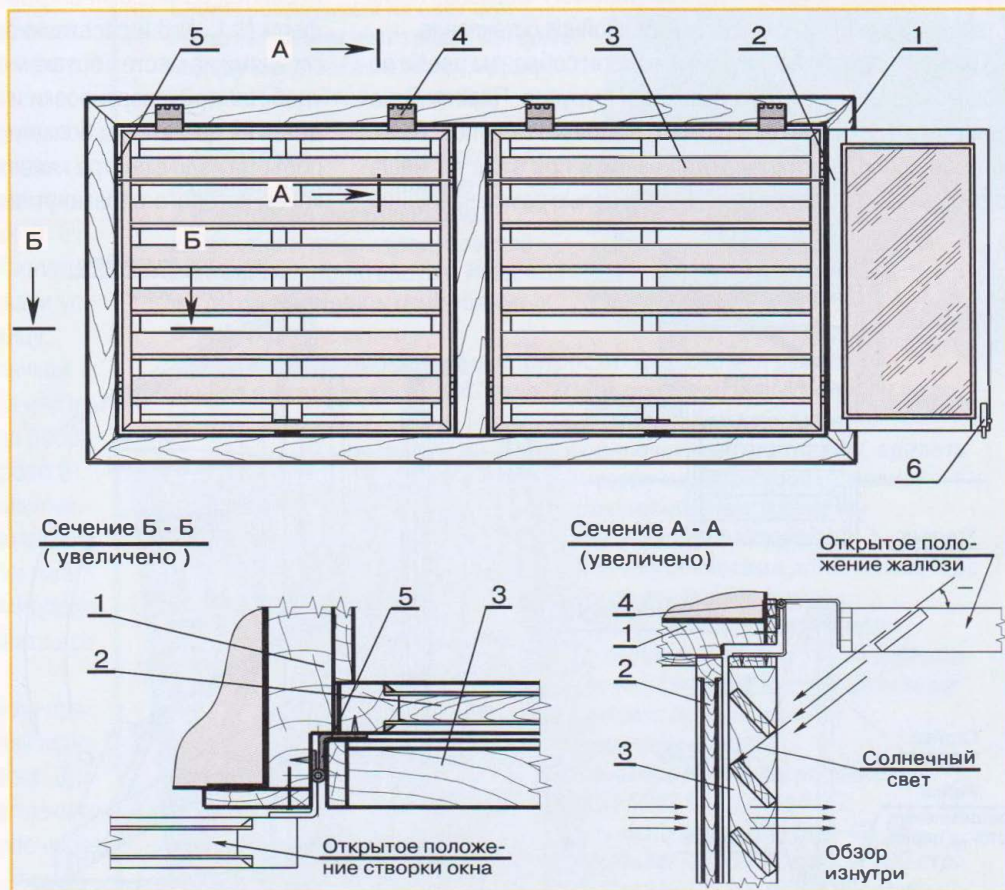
Конструкция оконного блока с двойным остеклением и решеткой жалюзи: 1 — коробка; 2 — створка; 3 — жалюзи; 4, 5 — шарниры; 6 — шпингалет.
